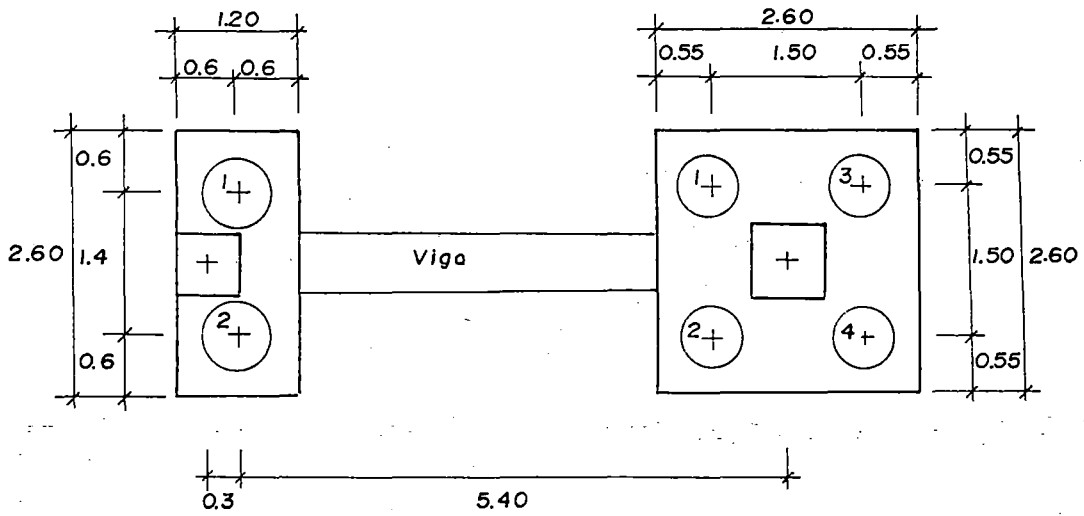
Zapata conectada, disposición de pilotes.
